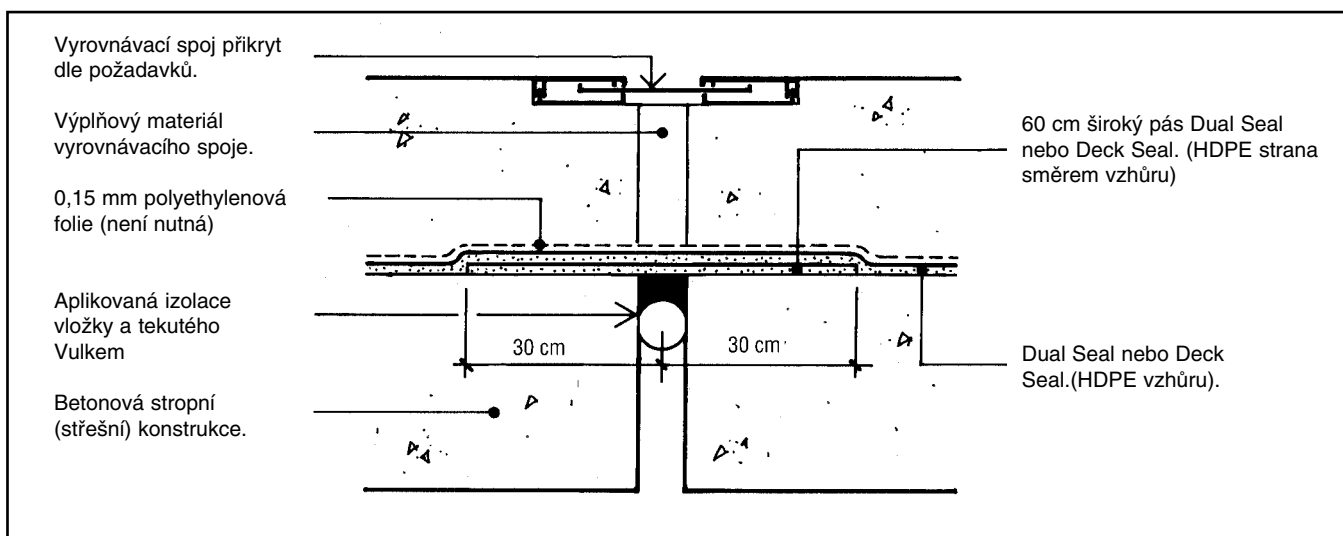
Izolace spodní hrany stropní konstrukce.
